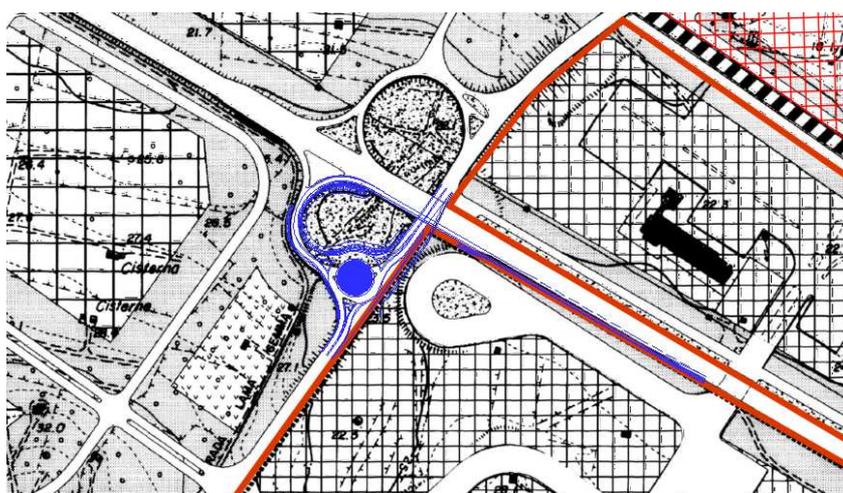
Stralcio sovrapposizione "Bretella di collegamento" al PRGC Molfetta
